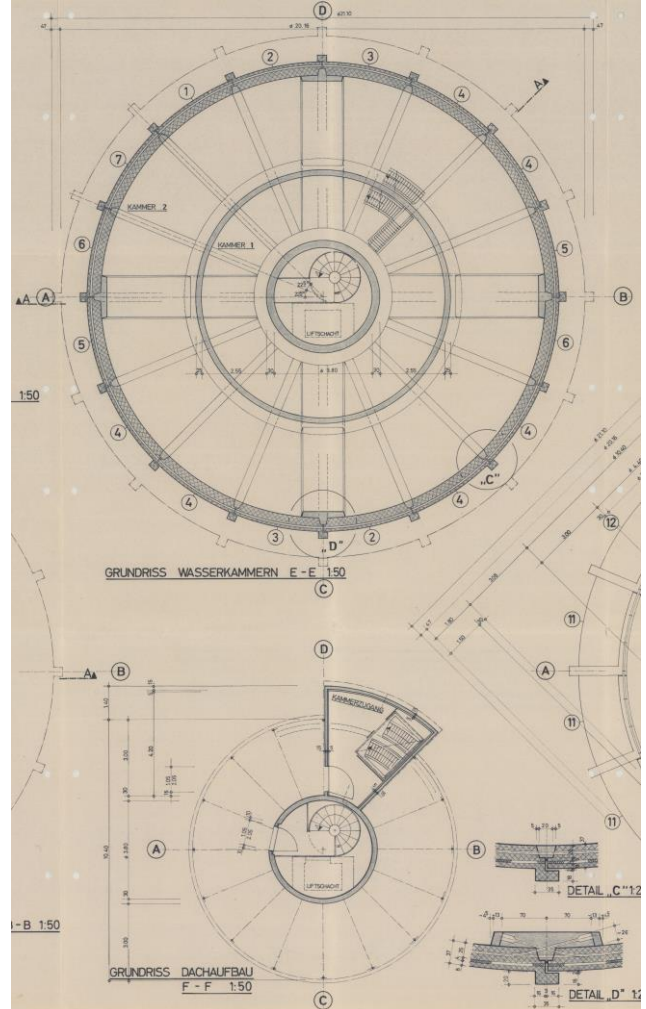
Grundriss aus Grundlagen [1]
